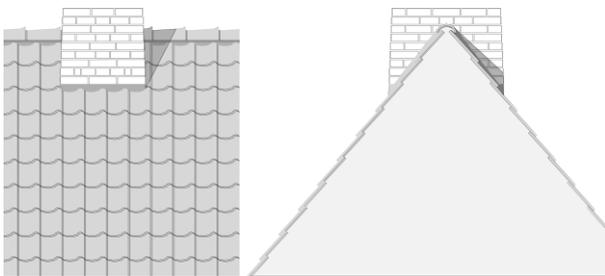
Haustyp VI, Schornstein und Ortgang
